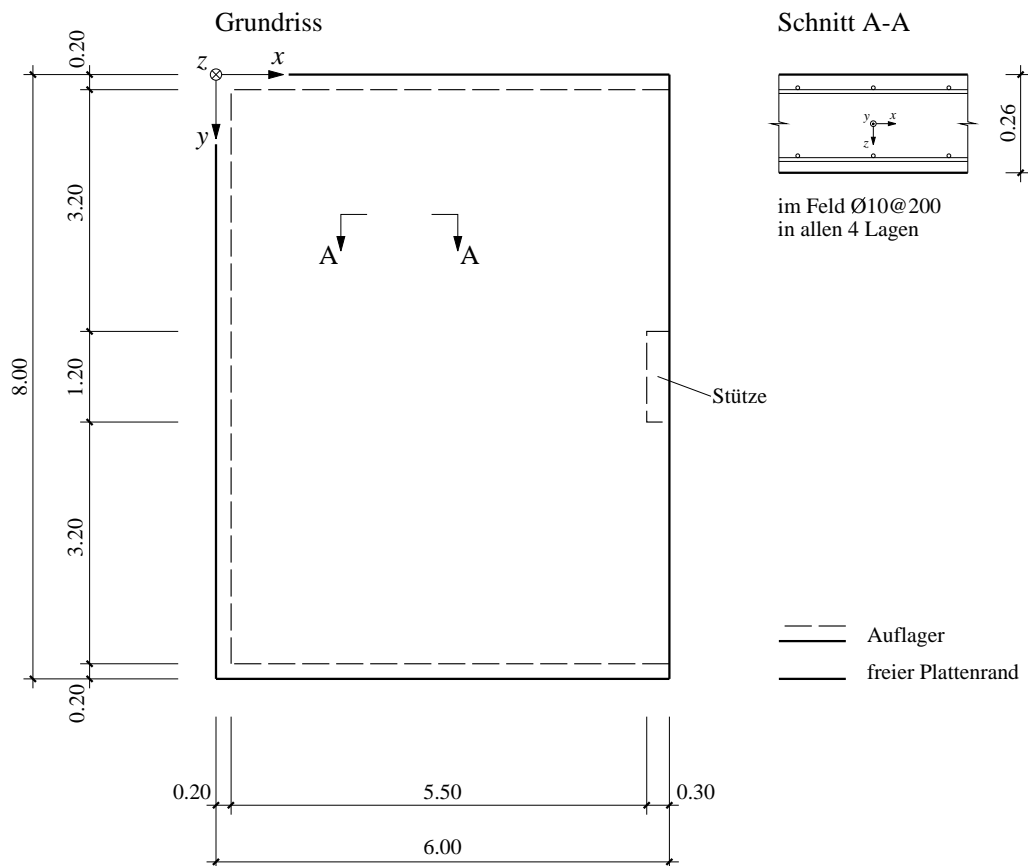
Grundriss und Detailschnitt der in Aufgabe 3 behandelten Stahlbetonplatte.
